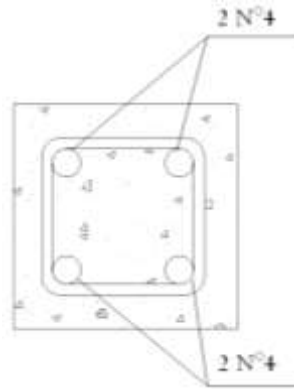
Corte transversal de la viga con detalles de diseño a flexión
